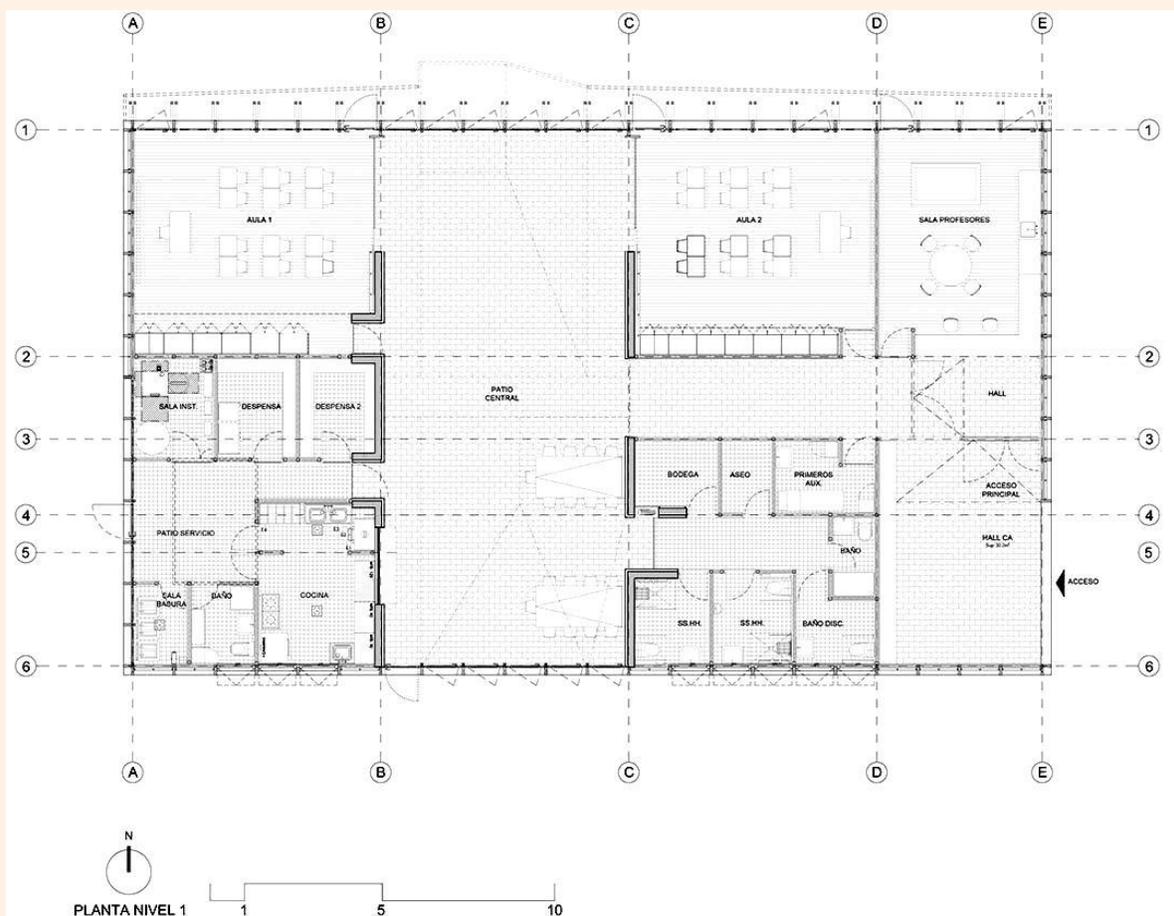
Planta arquitectónica, rescatada de <https://www.duquemotta.com/escuela-pivadenco>
